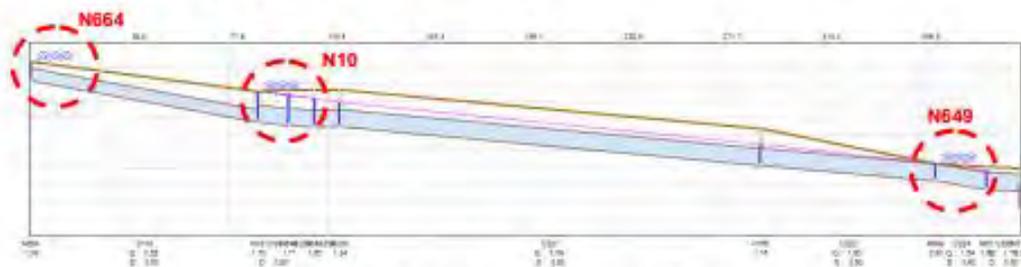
Profil de l'avenue Jean Moulin pour T = 30 ans après renforcement du secteur pour une protection pour T = 10 ans
